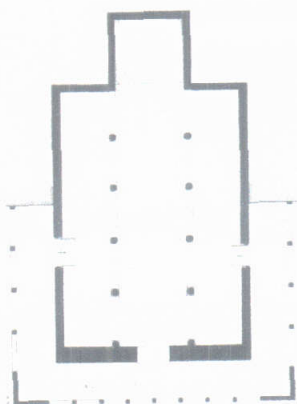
Planta Ntra. Sra. de Alcantarillas.
